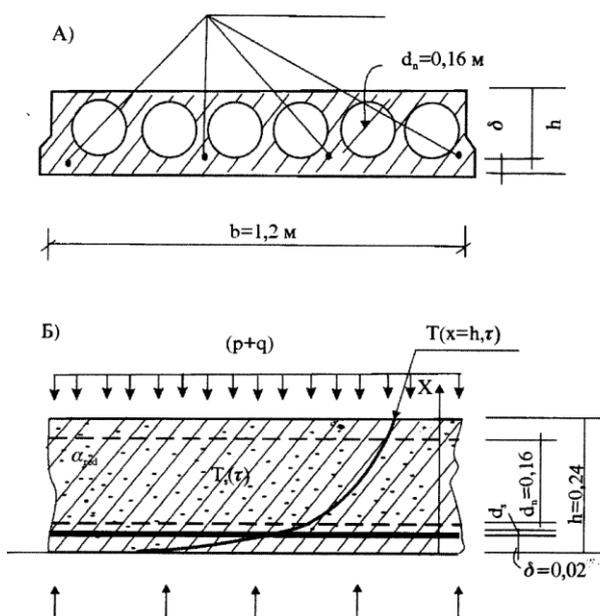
Схема для расчета предела огнестойкости железобетонной многоруствотной плиты перекрытия: А) поперечное сечение плиты; Б) расчетная схема определения предела огнестойкости плиты
